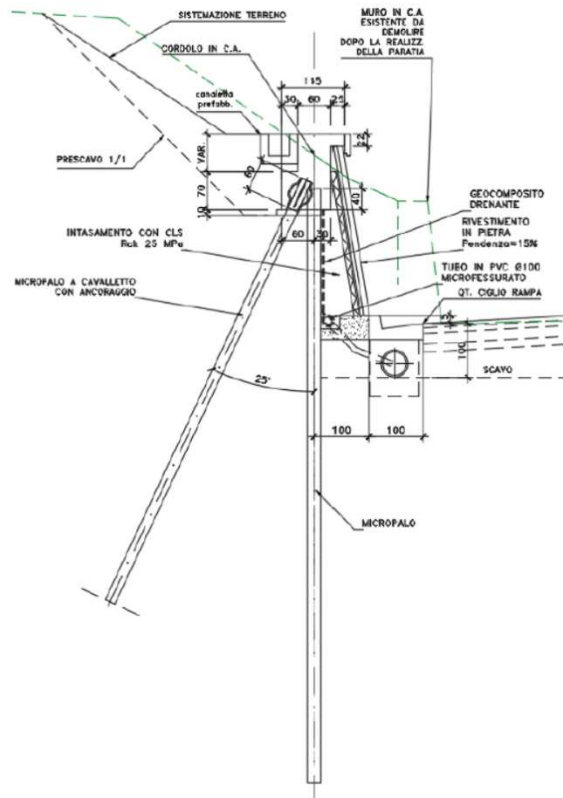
Elenco e sezione tipo muro di sottoscarpa
